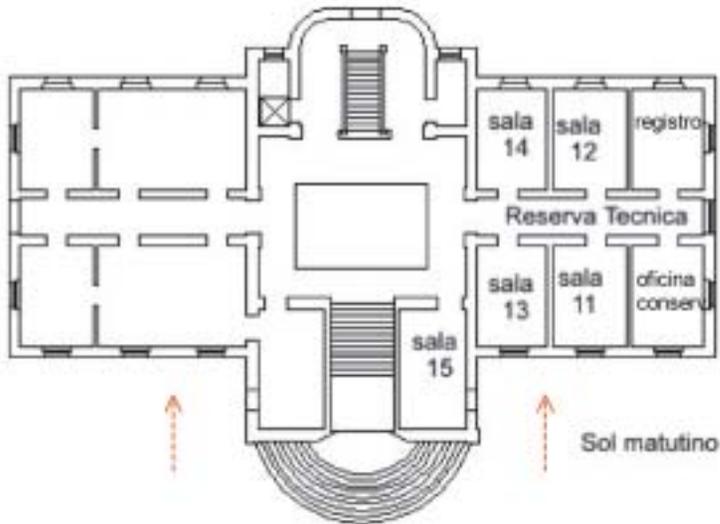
Planta do pavimento onde se localiza a maioria das salas da Reserva Técnica.
